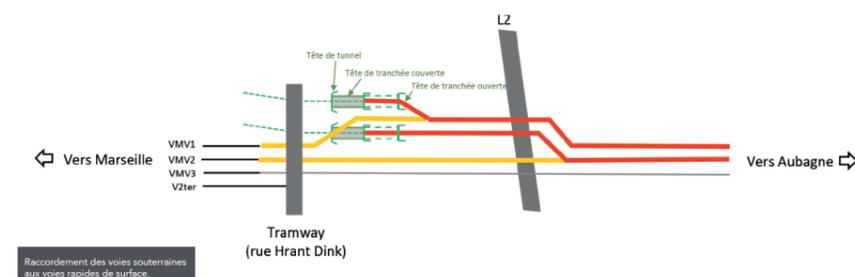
Principe de raccordement des voies du tunnel avec les voies rapides provenant du plateau de surface
